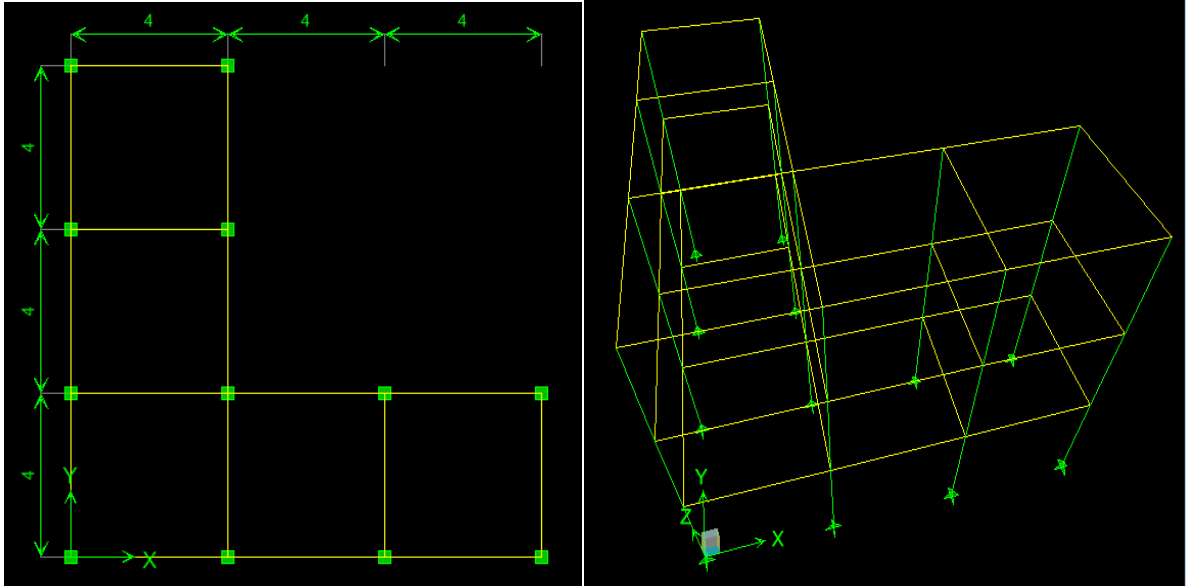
la géométrie en plan et en élévation de la structure.
